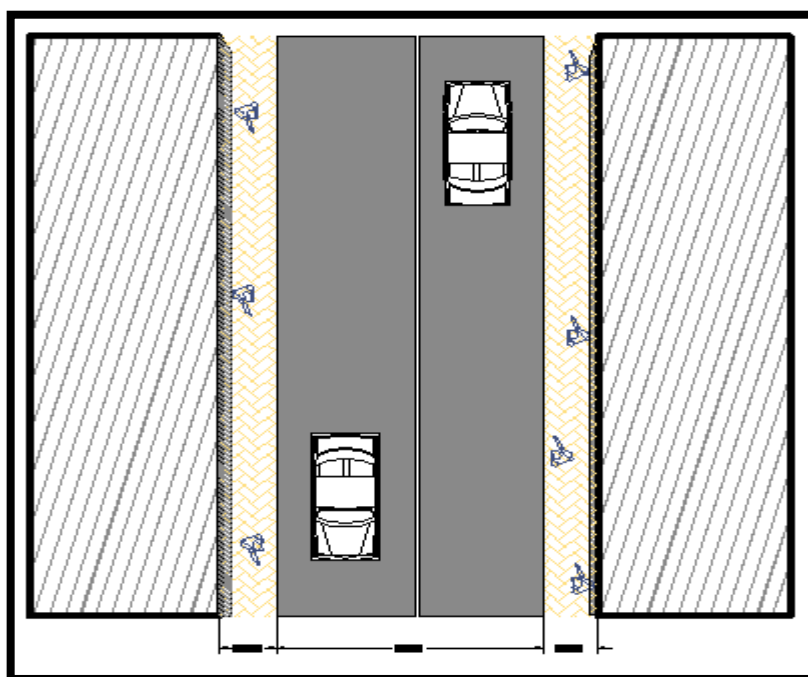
vue en plan d'une voie tertiaire (10m)
